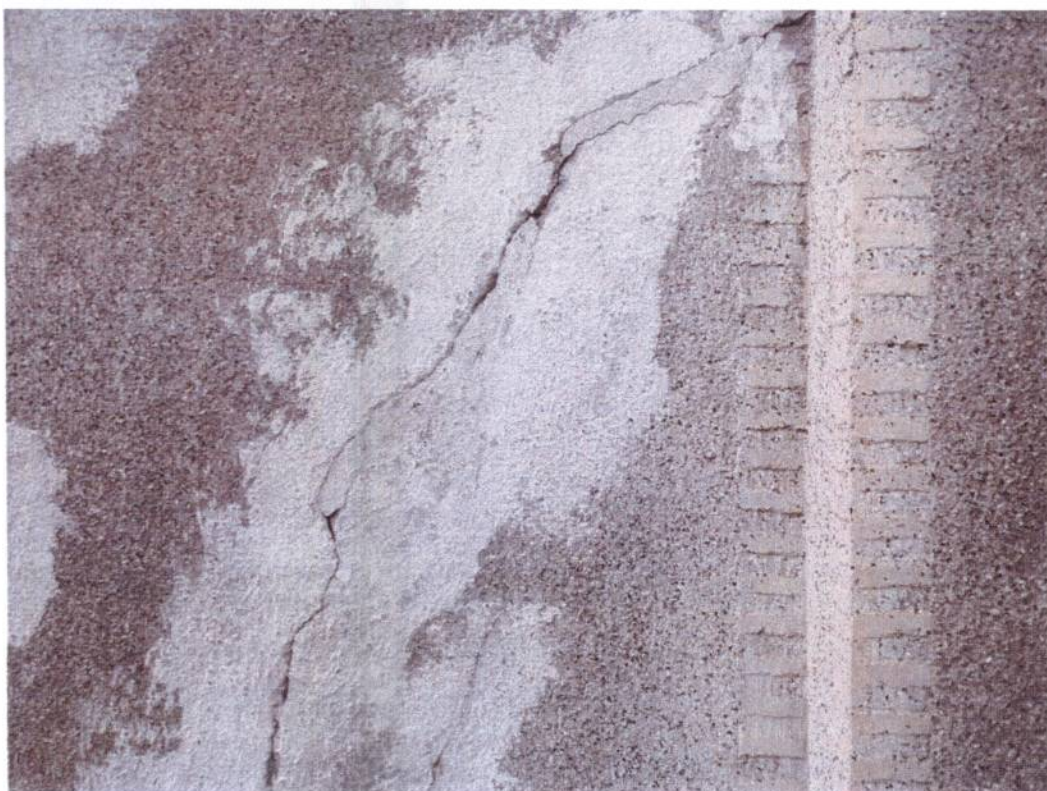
Pohled na vyšetřovanou konstrukci betonové římsy
